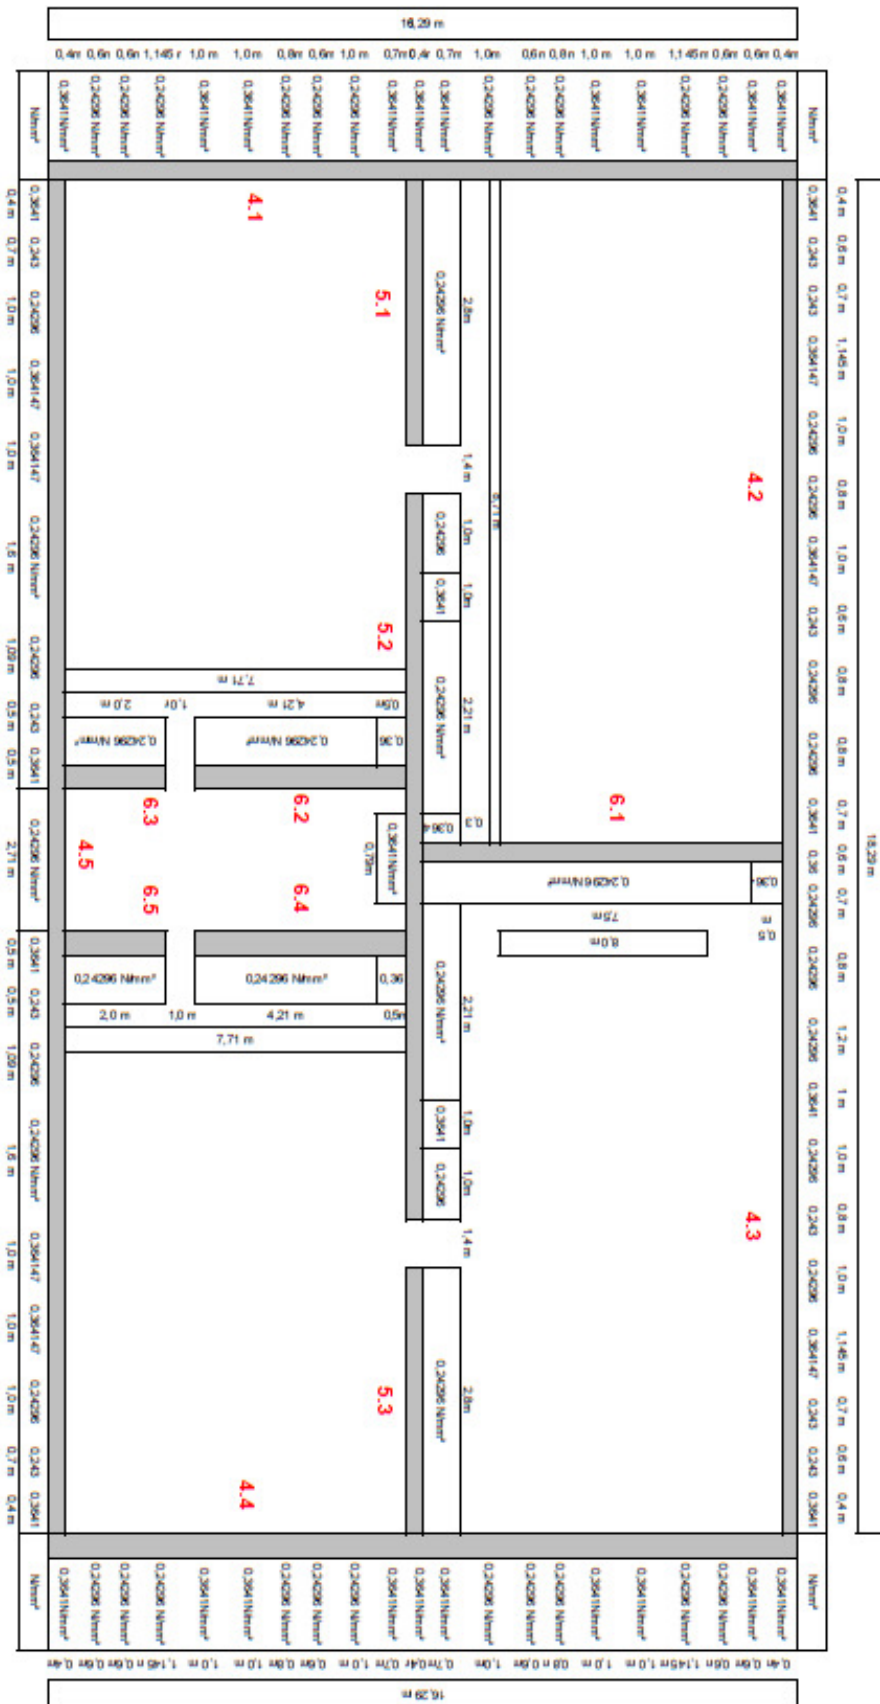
Positionsplan der Sylomer®-Lagerstreifen zwischen der Decke über dem ersten Obergeschoss und der tragenden Wand (Decke über 1OG)
